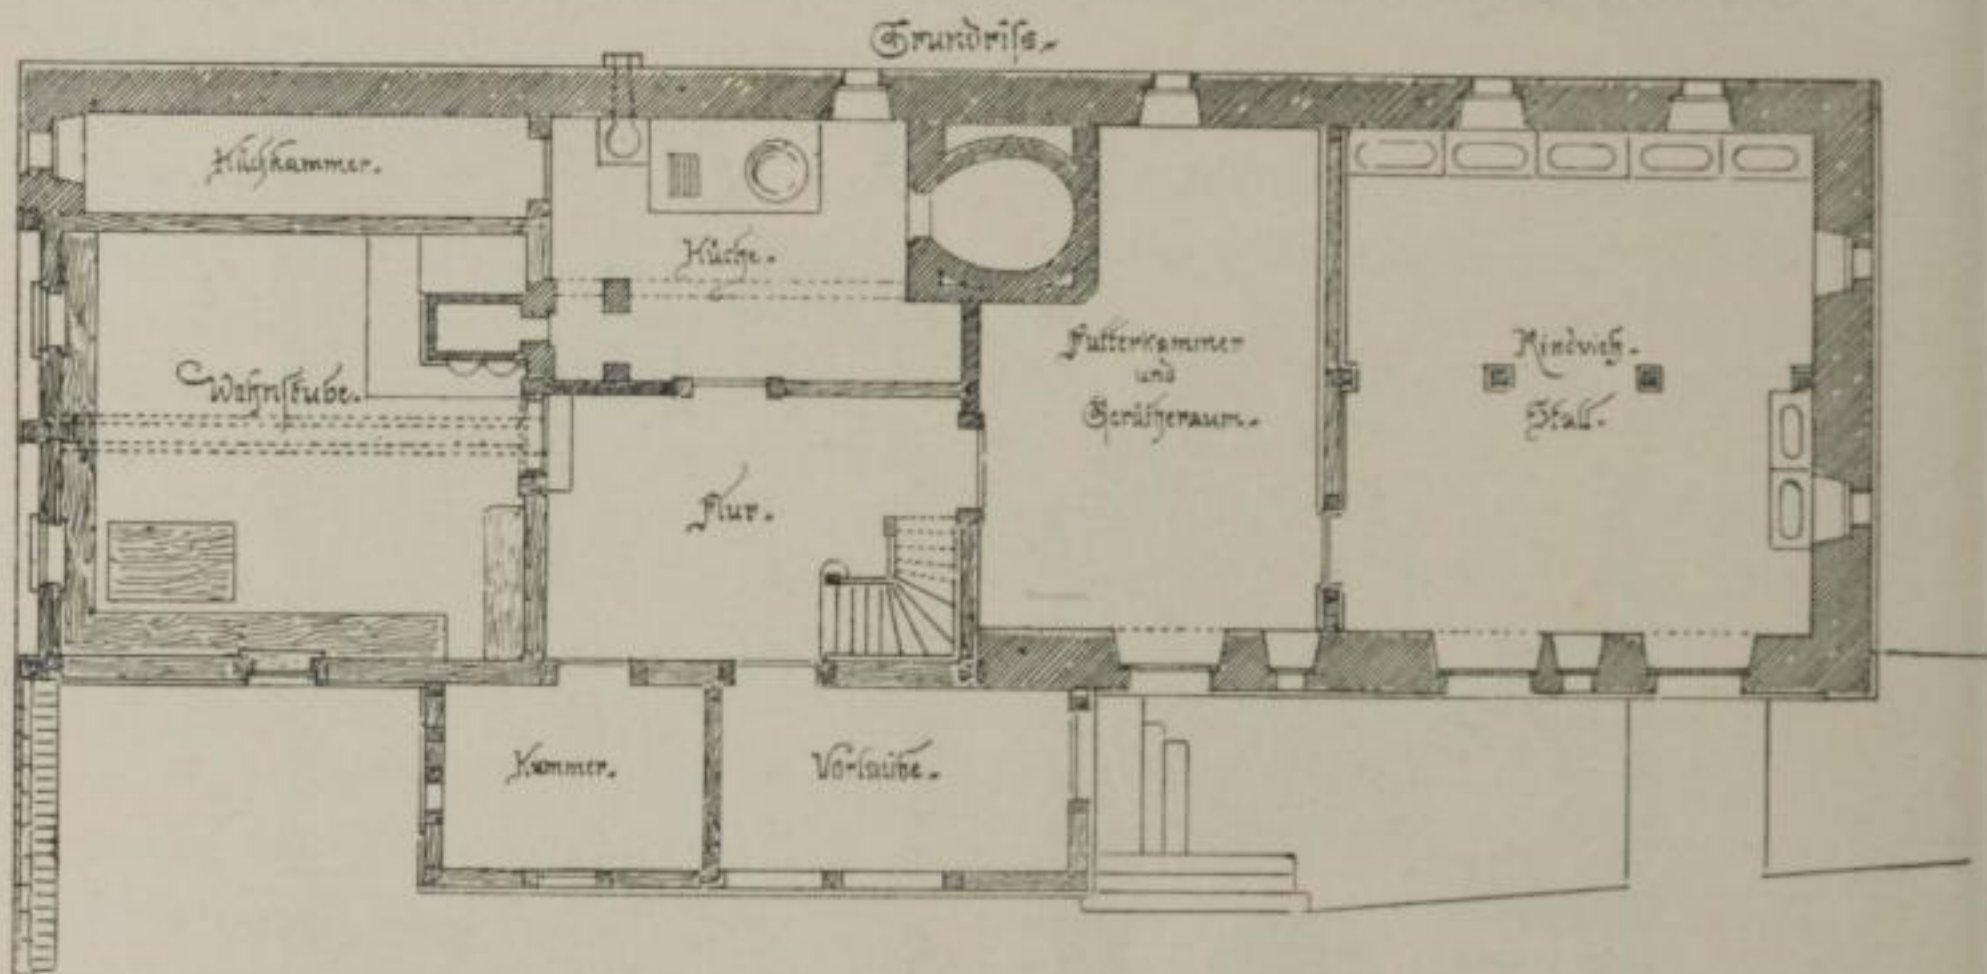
Grundriß eines Bauernhauses aus Heilingen (S.-M.).
